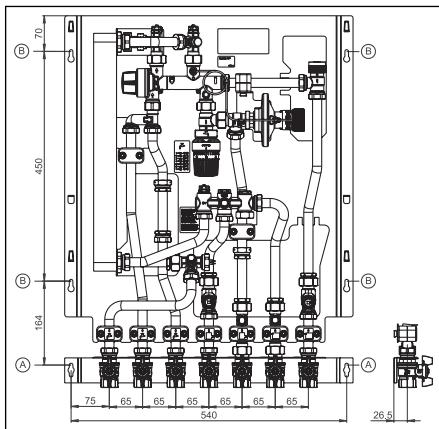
Anschlussschema Kugelhahnanschlussleiste 1341180
